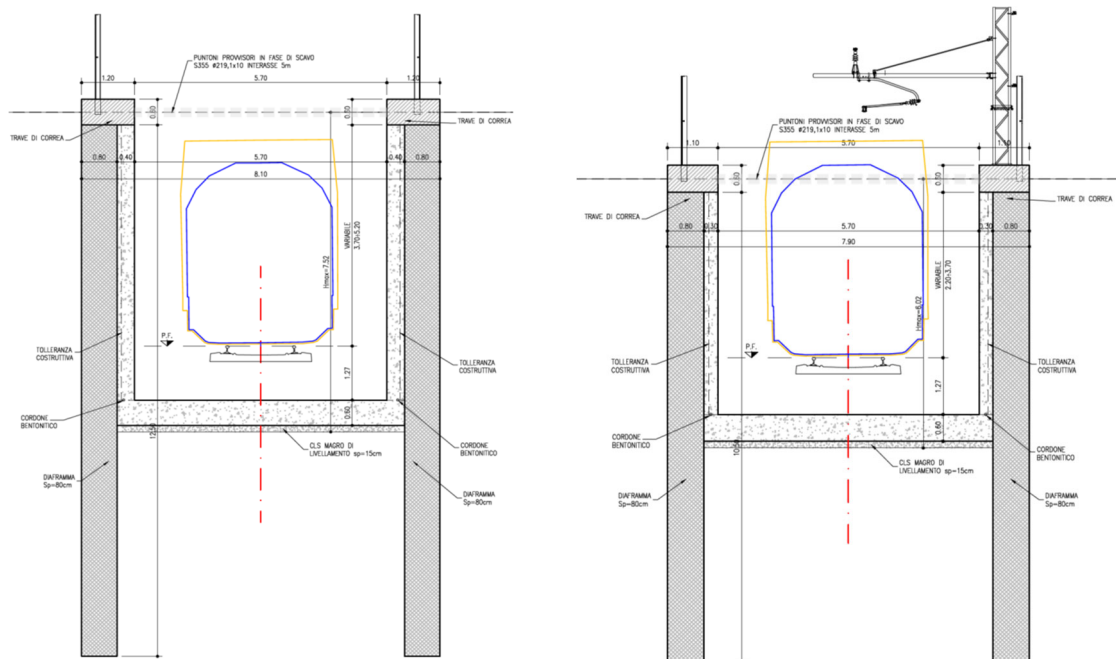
Scavo con diaframmi – sezione TIPO 7a \ 7b
